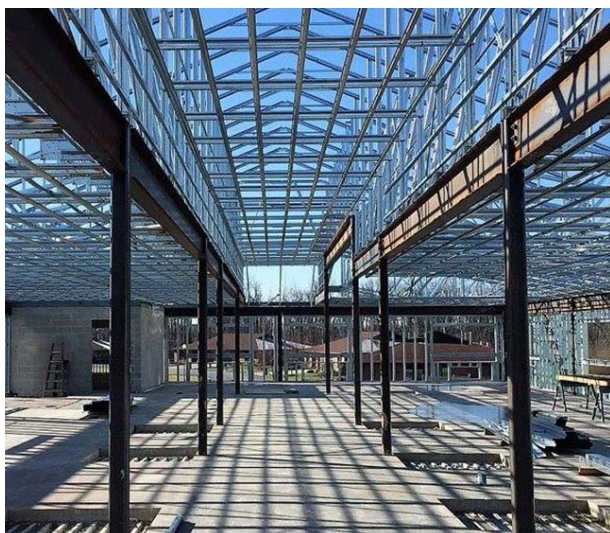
Sistema costruttivo a telaio in acciaio (Credits: Limberlost Construction, Inc.: www.limberlostconstruction.com)
